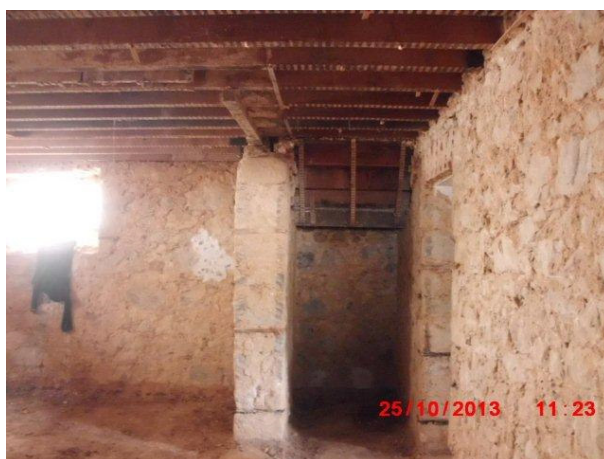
Piso Térreo: Paredes estruturais e estrutura do pavimento do Piso 1
